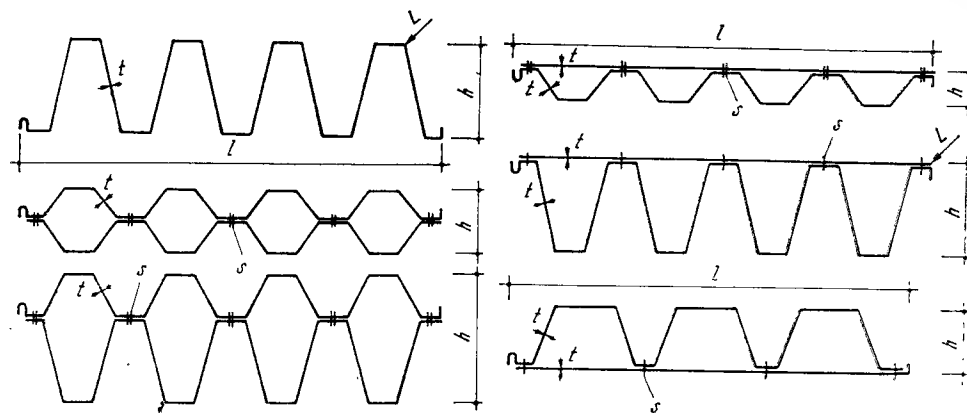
Secțiuni transversale prin elemente de planșeu din tablă de oțel:
